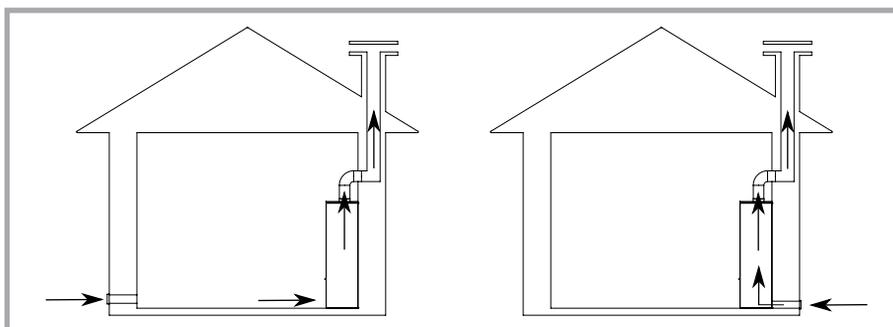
Installazione mediante presa d'aria nel locale e installazione con presa d'aria esterna collegata direttamente alla stufa a legna.
